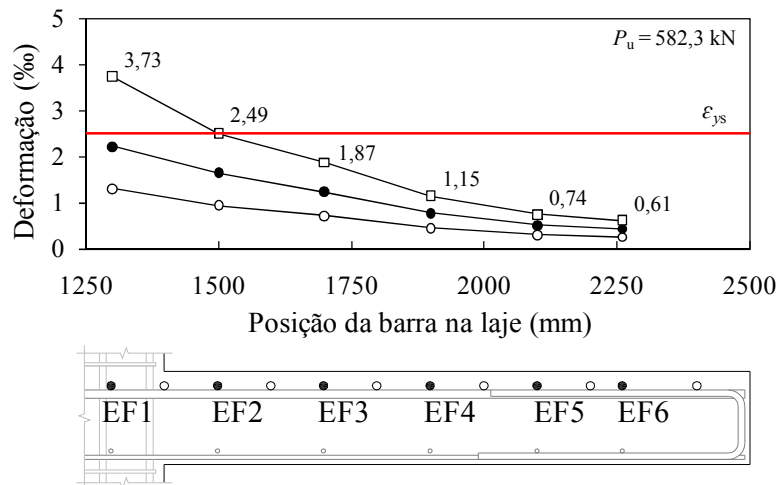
Deformações nas armaduras de flexão da laje LS06
